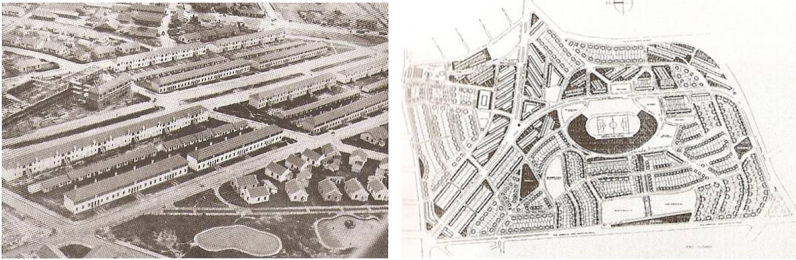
a) Vista geral do Conjunto. b) Implantação. Fonte: Bonduki (2004).
